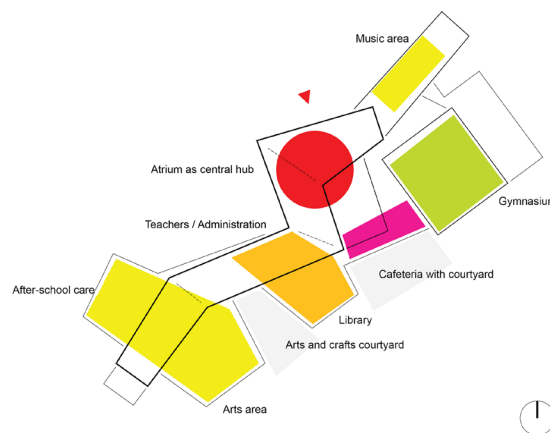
New Ergolding Secondary School. Layout funzionale atrio centrale
